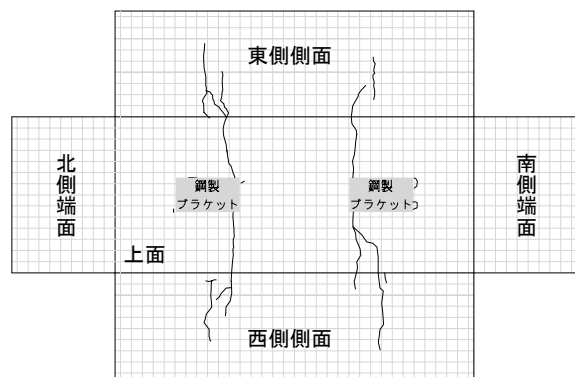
ひび割れ損傷図 (1050kN 時)
